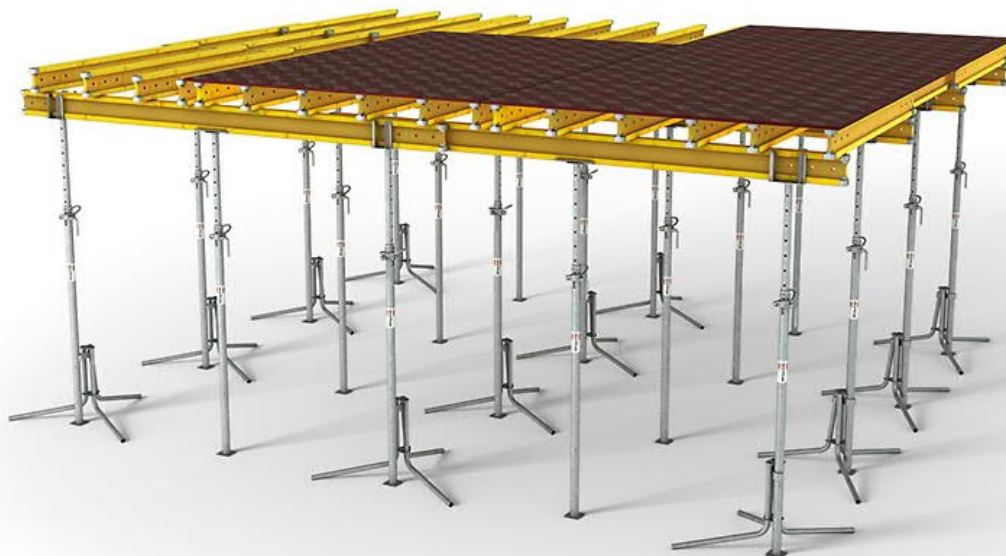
MULTIFLEX, опалубка для перекриття
